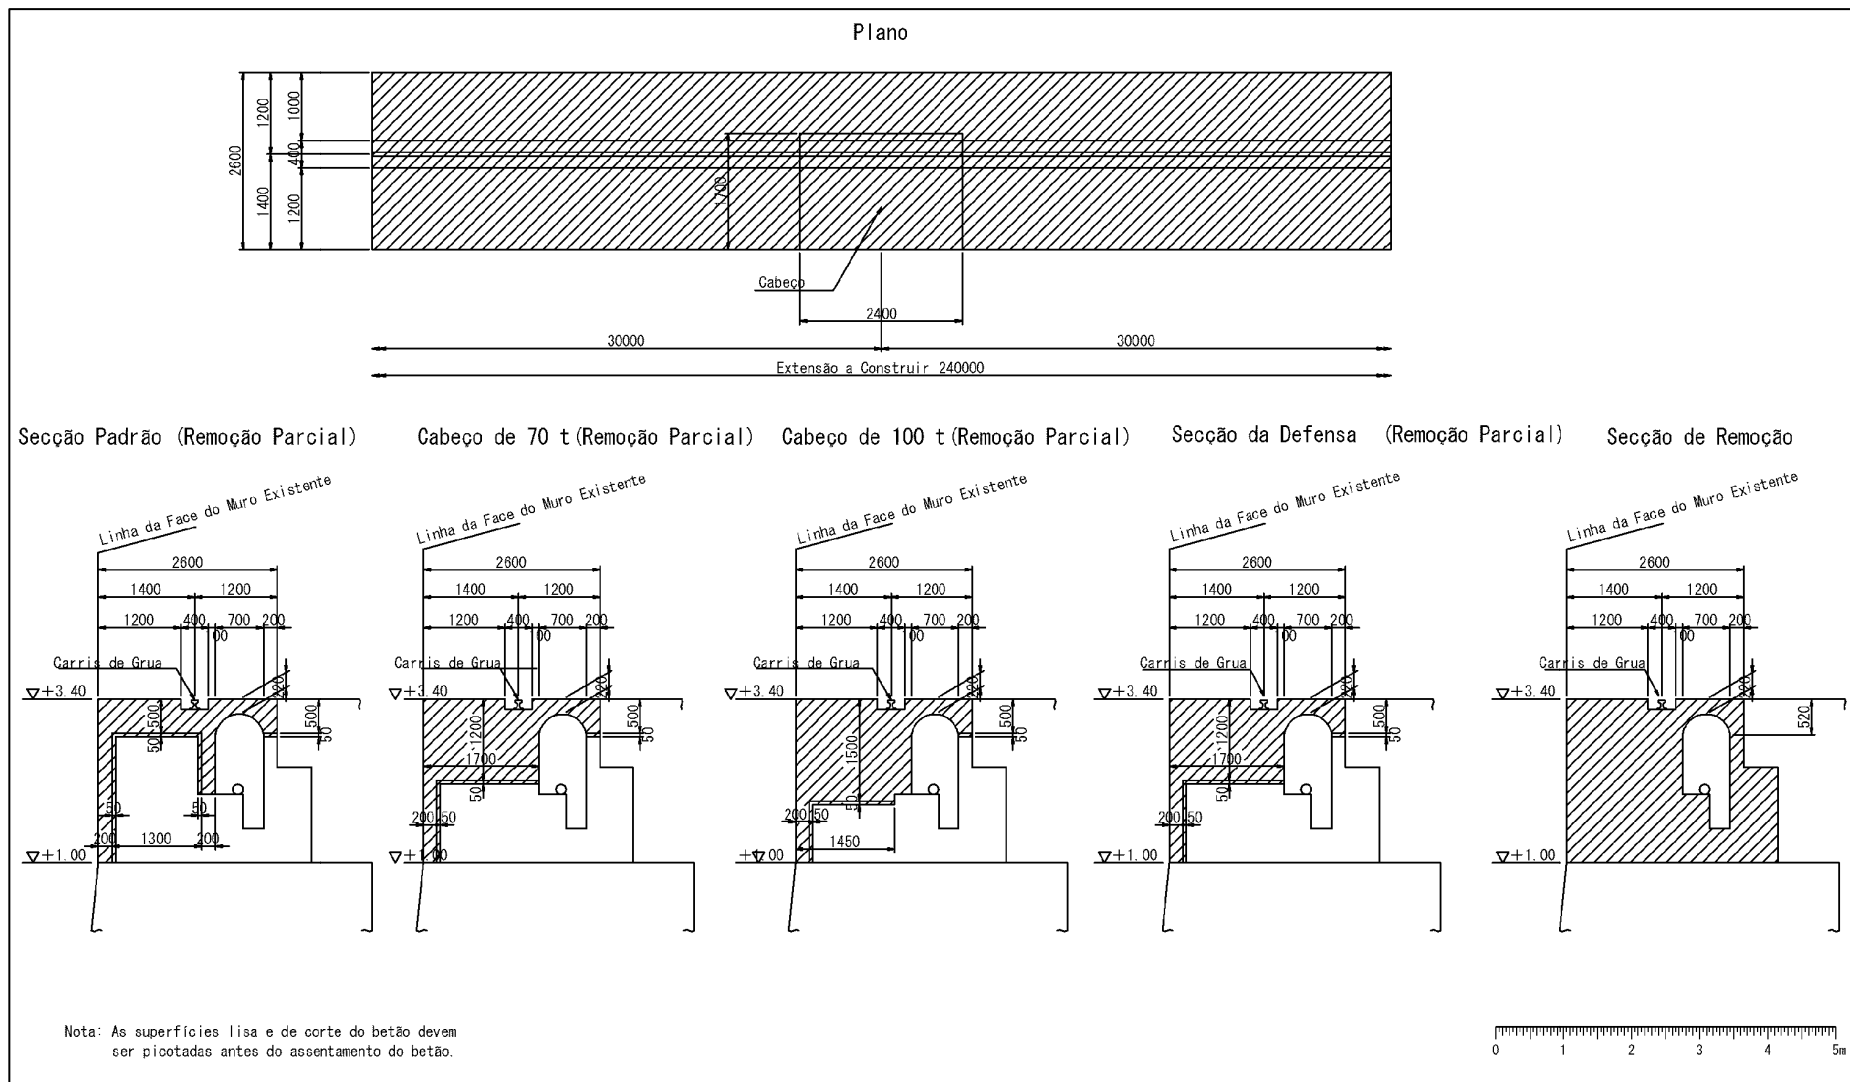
Planta de Remoção do Coroamento do Muro
